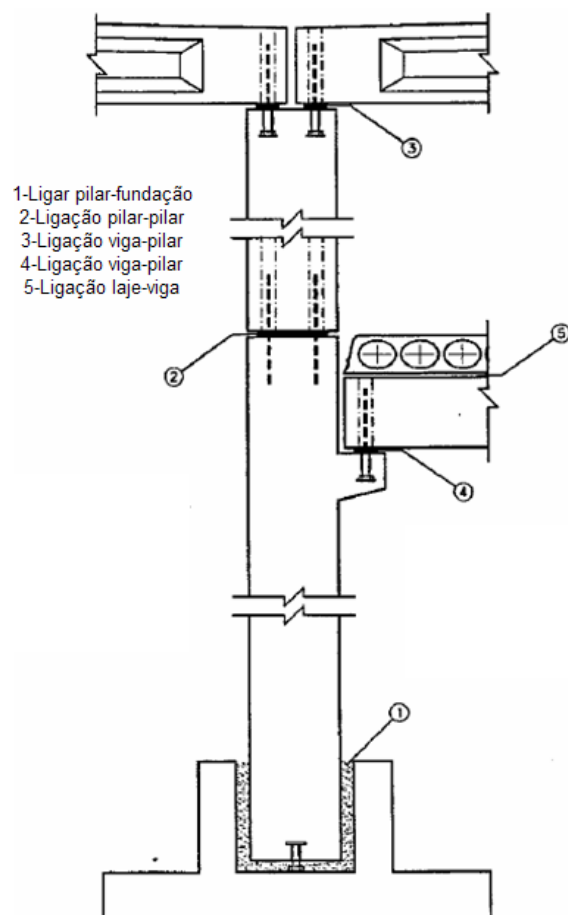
Ligação Pilar – Fundação, Pilar – Pilar, Viga – Pilar e Laje – Viga (adaptada de [1])
